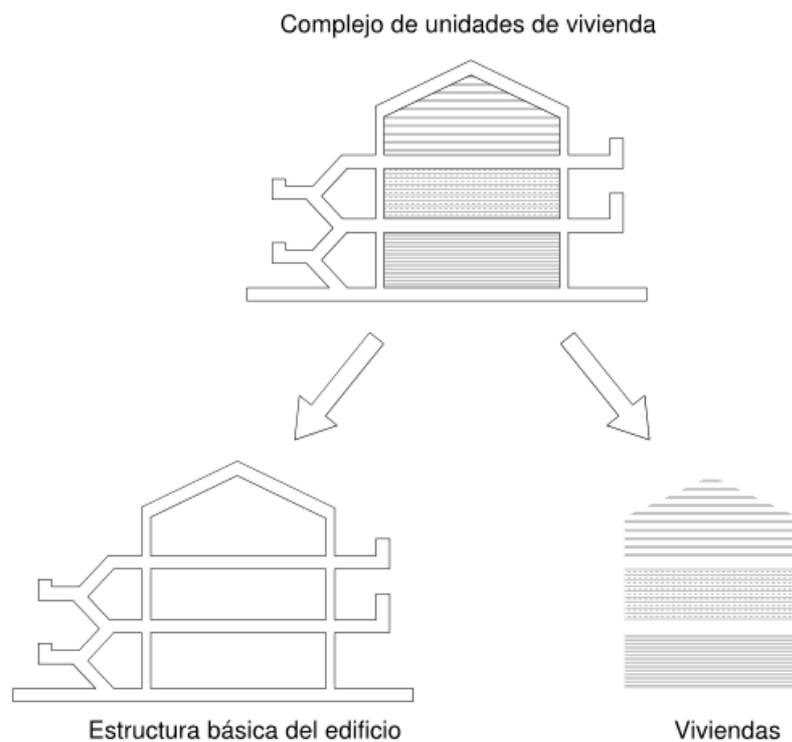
División en el proceso de diseño en estructura y unidad de vivienda, Fuente: elaboración propia
